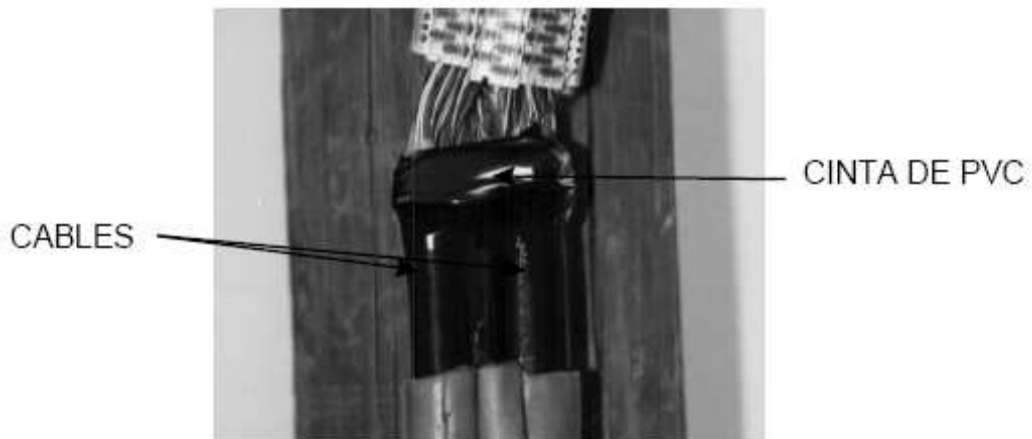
Aplicación de la cinta de PVC sobre los conectores y la malla conductora.
